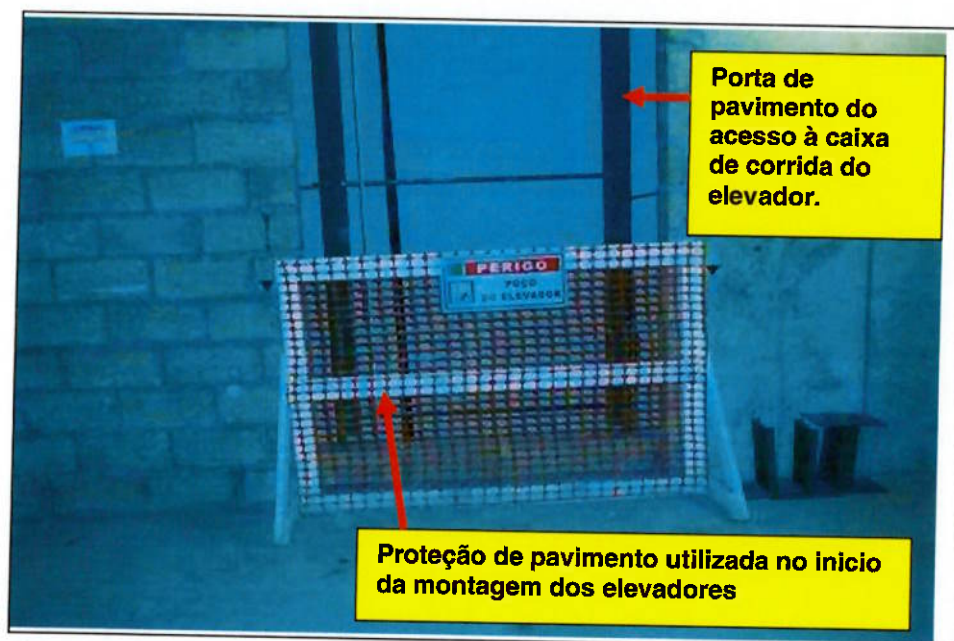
Proteção de pavimento utilizada no início da montagem dos elevadores
